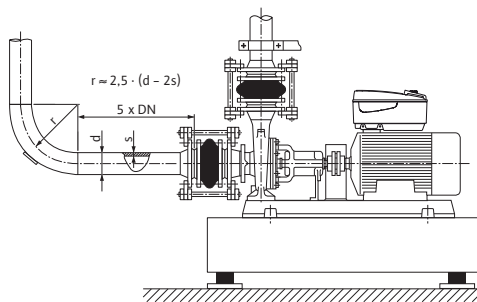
Подсоединение насоса без создания механических напряжений, участок выравнивания потока перед и за насосом
